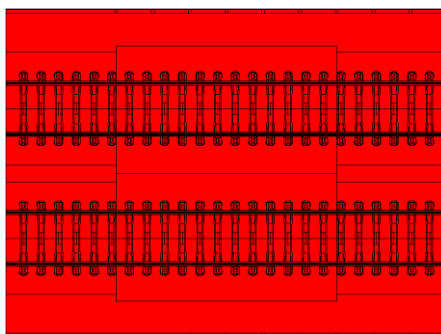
Exemplo das áreas da laje de betão considerada para o cálculo das armaduras transversais na plataforma ferroviária
